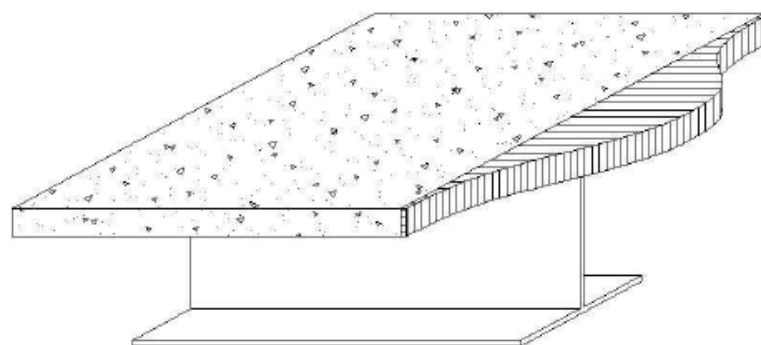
Distribuição de tensões de compressão na laje de concreto
